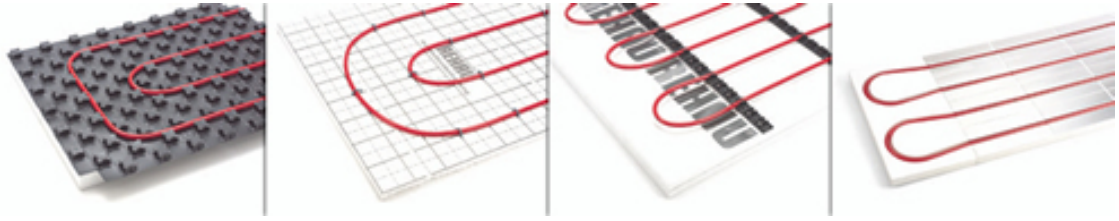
Sistemas de aquecimento/arrefecimento por superfícies radiantes [22].
